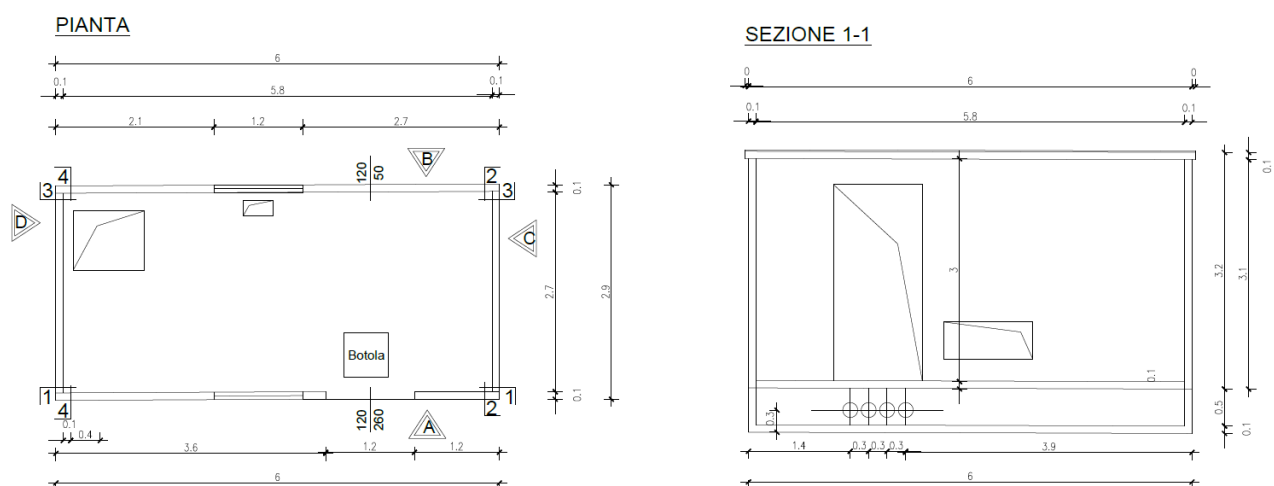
pianta e sezione della stazione di sottocampo (power station).
